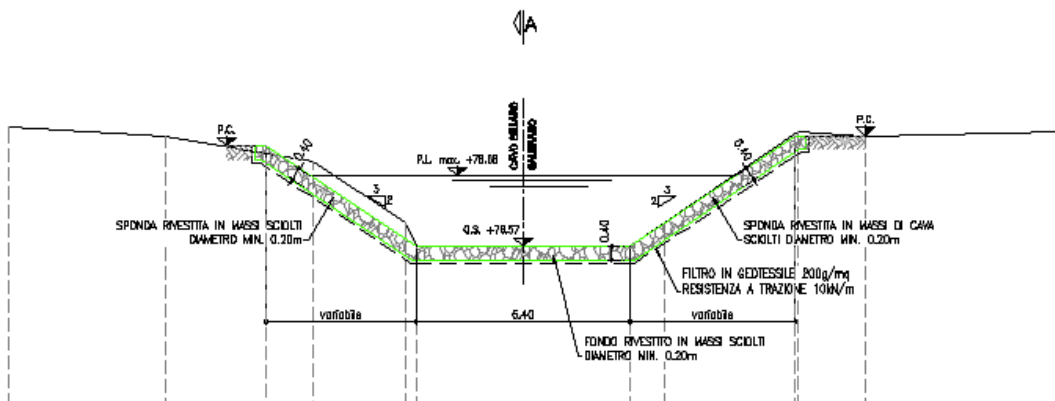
Sezione trasversale della sistemazione di valle del Cavo Sillaro Salerano.
